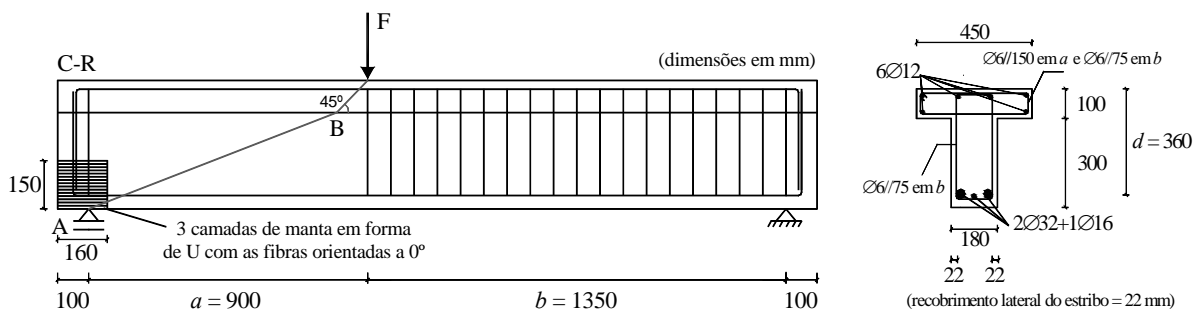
Geometria das vigas da série B ensaiadas por Dias e Barros (2010) (dimensões em mm).
